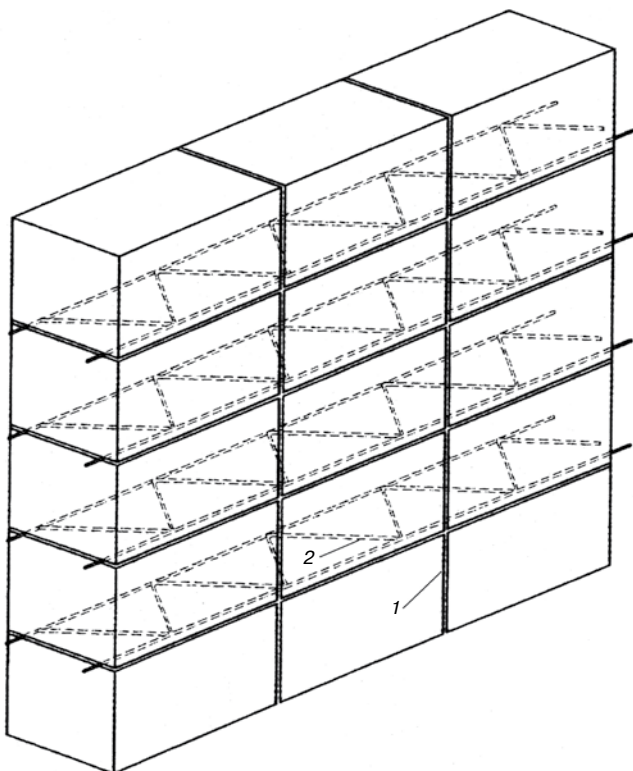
Фрагмент фасада здания с вертикальными неперевязанными швами: 1 – вертикальные швы; 2 – сетки армирования
